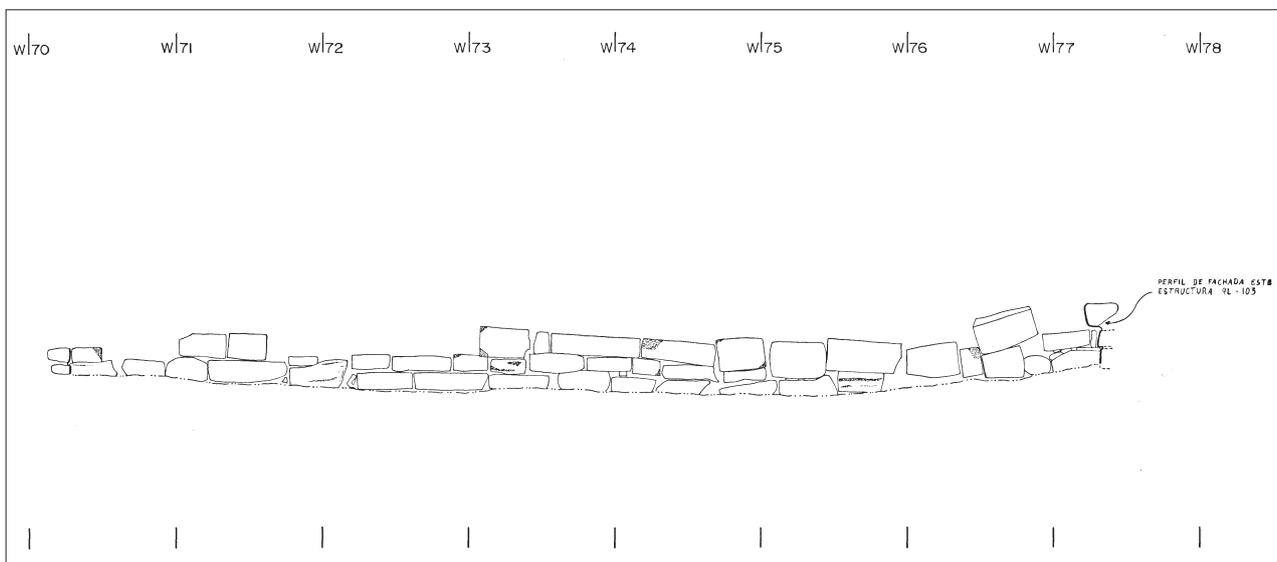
Fachada con vista al Sur de parapeto que cierra la plaza "B" con 9L-103
